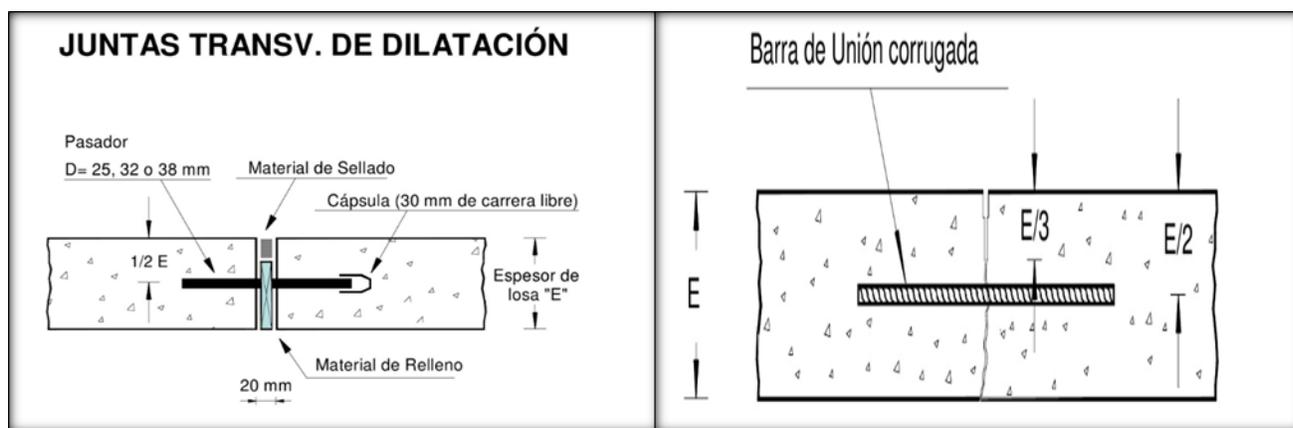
Juntas de unión Longitudinal de contracción y Transversal de dilatación.
